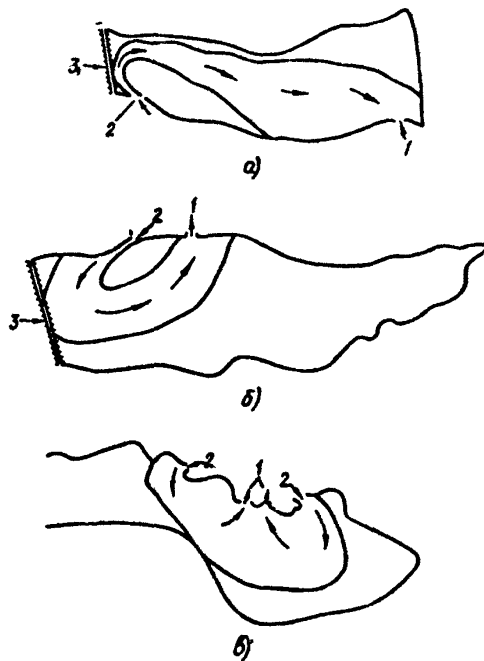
Схемы расположения (а, б, в) водозаборных и водовыпускных сооружений на вытянутых широких водохранилищах:
